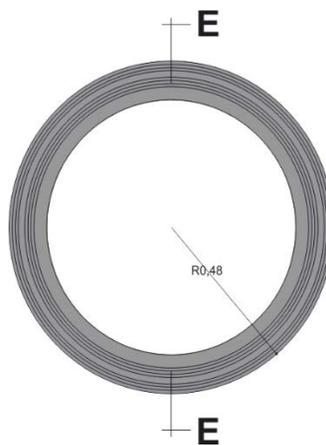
Detalle Rosetón, Estación del ferrocarril Sur.
